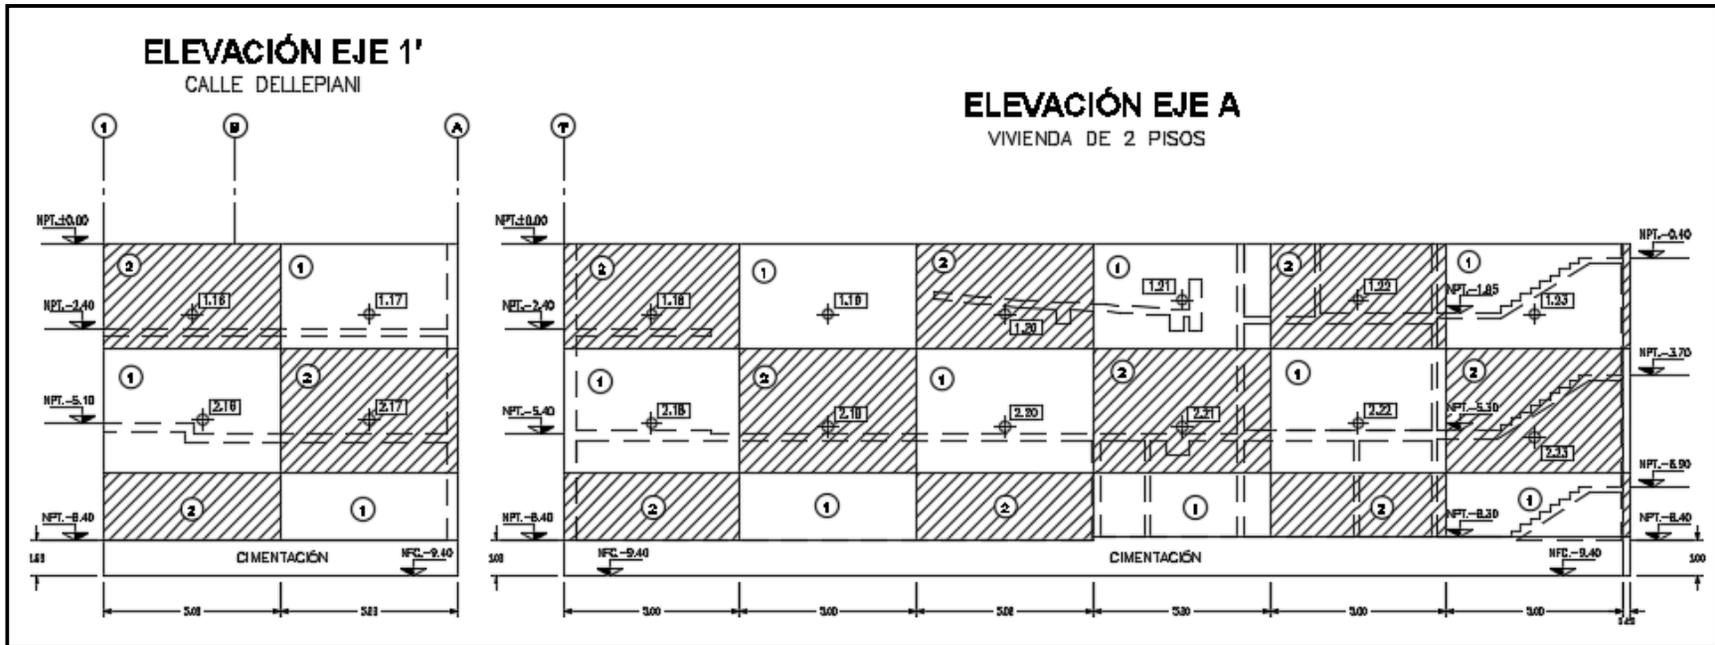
Elevaciones Ejes 1' y A obra 2: Edificio Crossland – Muro anclado.
